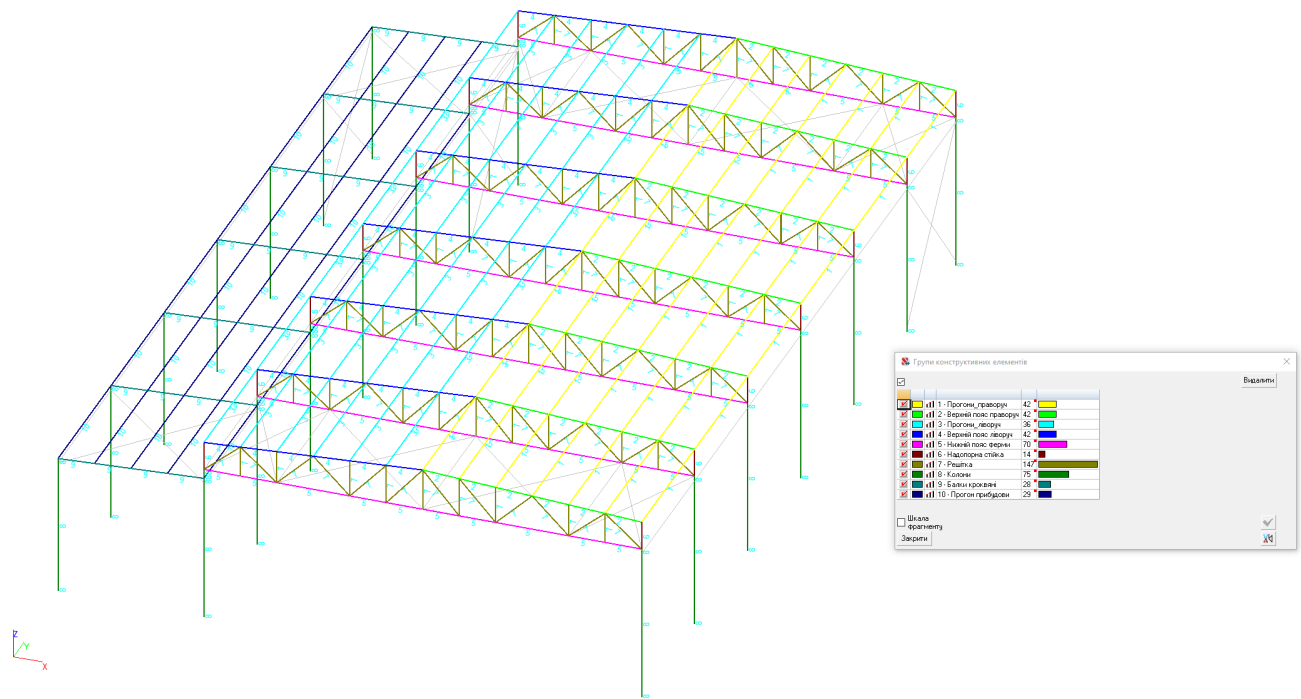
Розрахункова схема будівлі із групами конструктивних елементів
